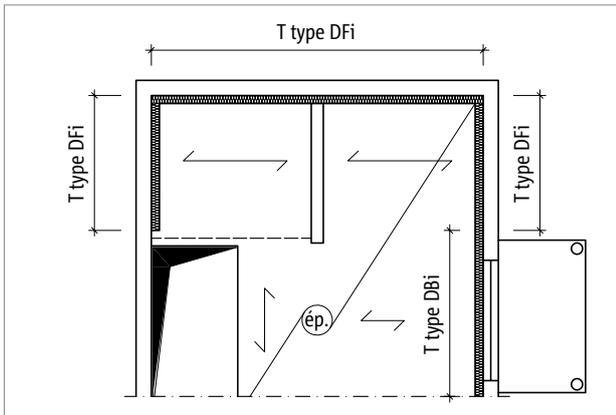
Schöck Rutherma® T type DFi : utilisation entre la dalle et la façade
